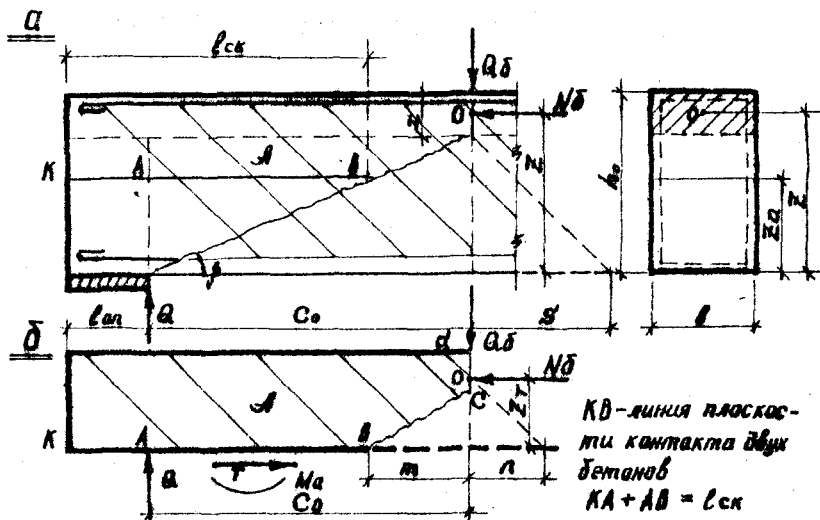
Расчетная схема балки на скалывание в плоскости контакта над крайней опорой
